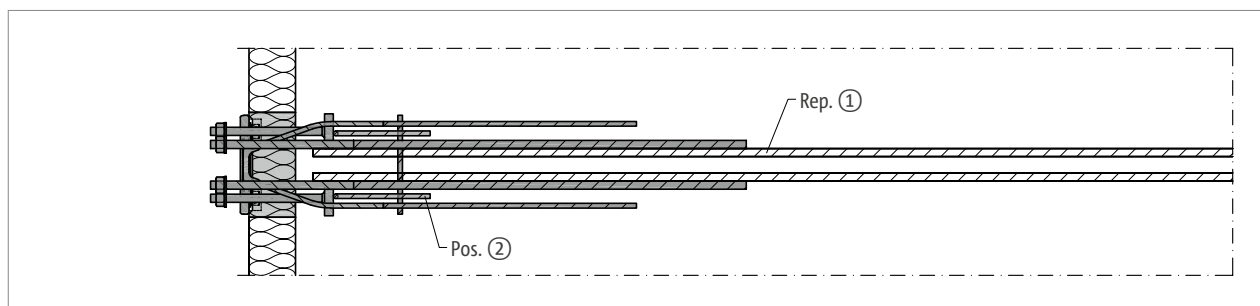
Schöck Isokorb® T type SK-M1 : renforcement sur site, plan de base
